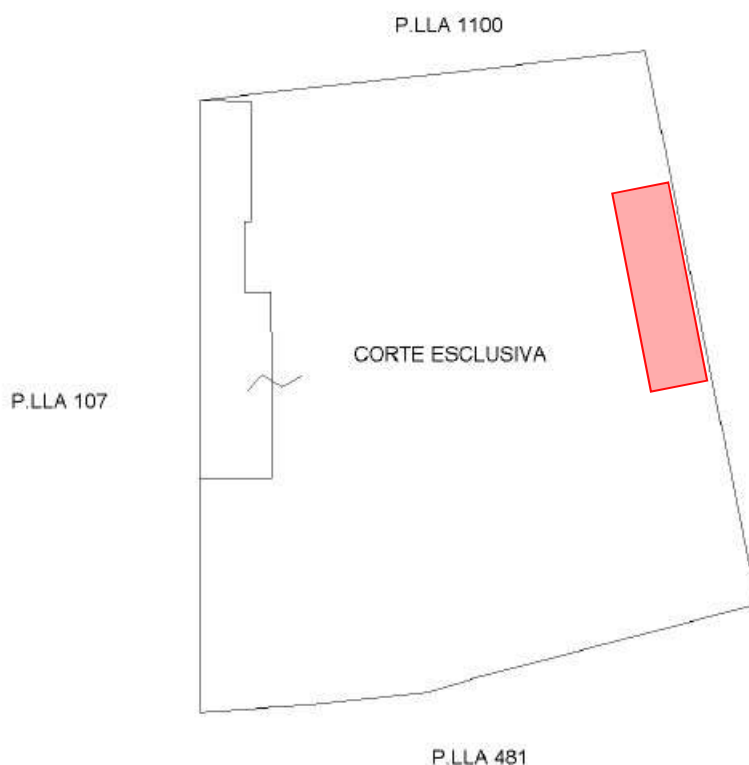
PLANIMETRIA DI CONFRONTO RILIEVO DELLO STATO DI FATTO E PLANIMETRIA CATASTALE
